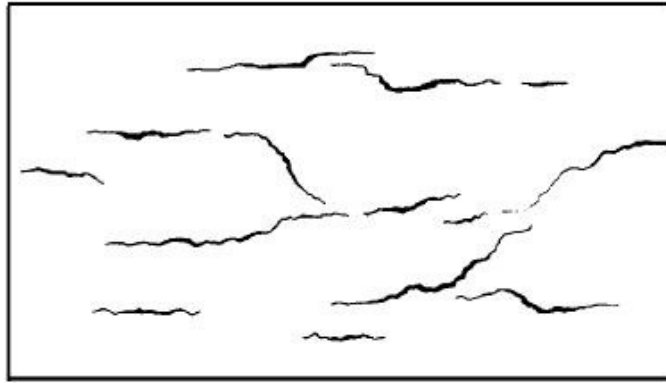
Típica Fisuración por Retracción Plástica.¹⁷
